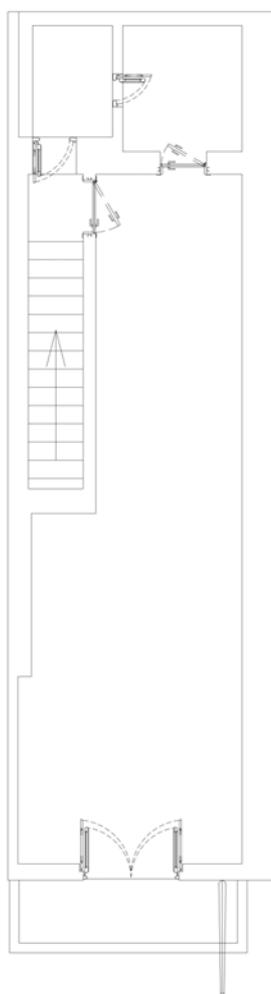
Planta Piso 1, Secção de Conservação de São Brás de Alportel, cedida por Museu do Traje de São Brás de Alportel
